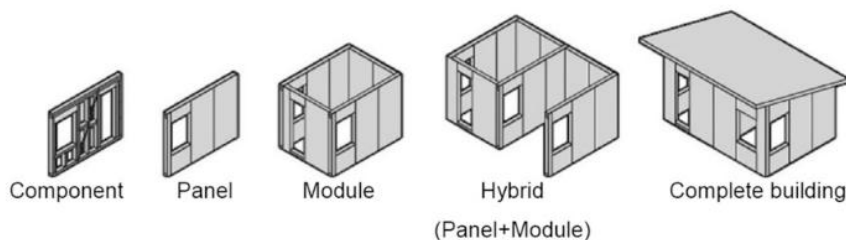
Diferentes fases da construção de uma estrutura prefabricada em betão, adaptado de [10].
